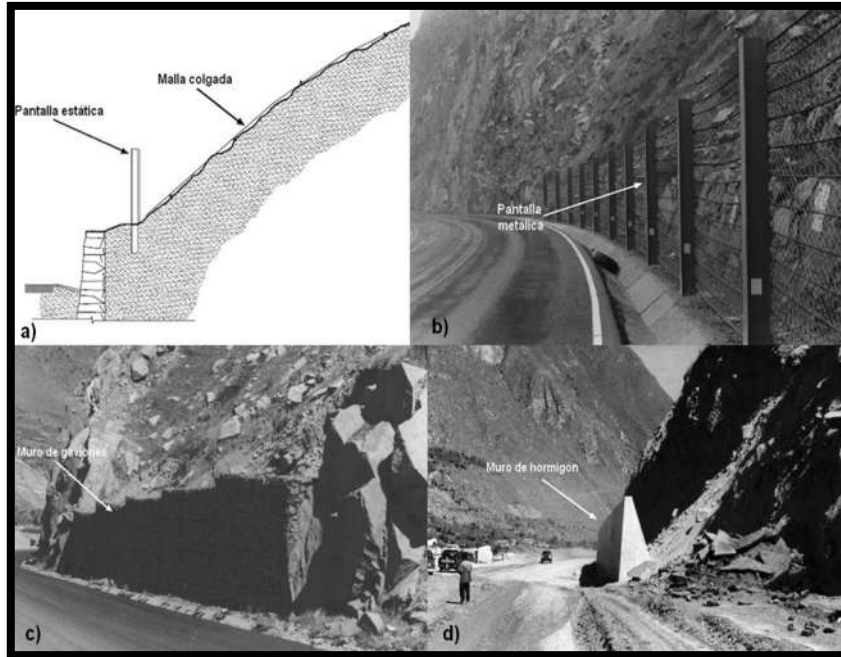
Barreras estáticas: a) Esquema de una pantalla estática trabajando en conjunto con una malla colgada; b) Pantalla metálica; c) Muro de gaviones; d) Muro de hormigón.
